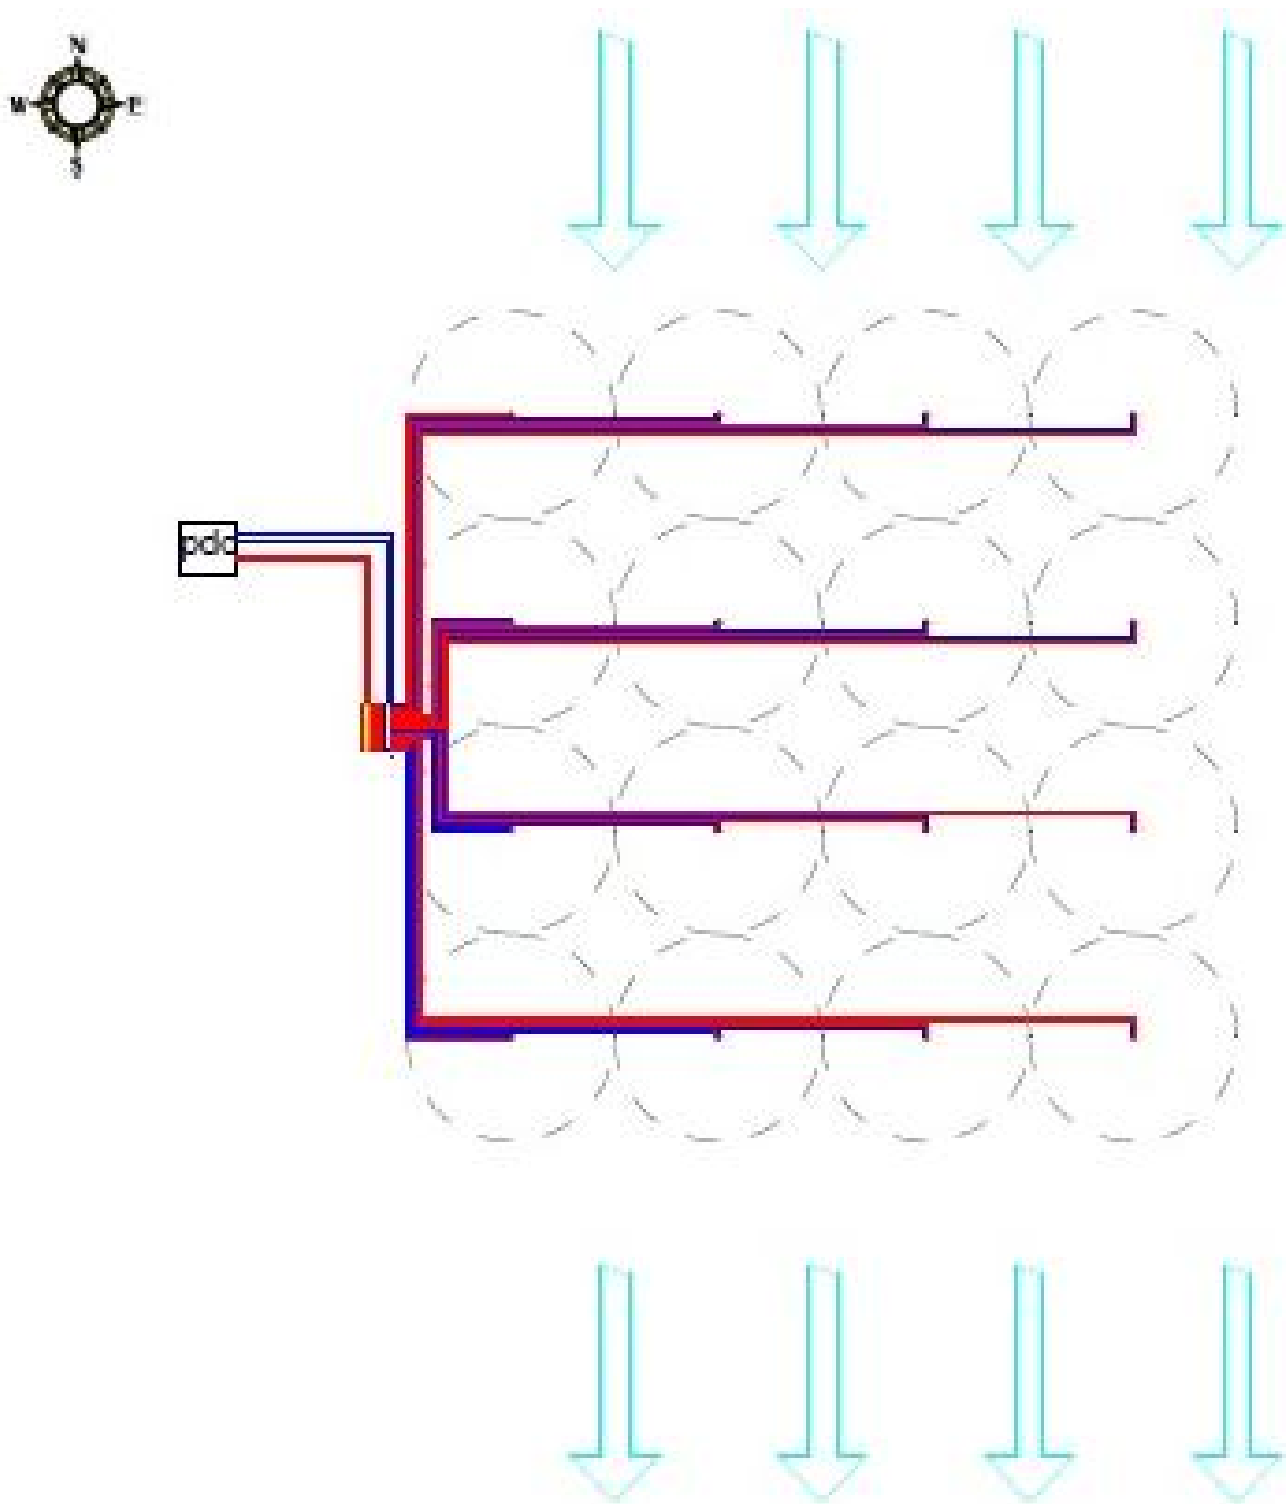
Pianta campo sonde geotermiche di esempio. Schema a 16 sonde in parallelo con collettore centrale e flusso di acqua di falda nella direzione N-S
